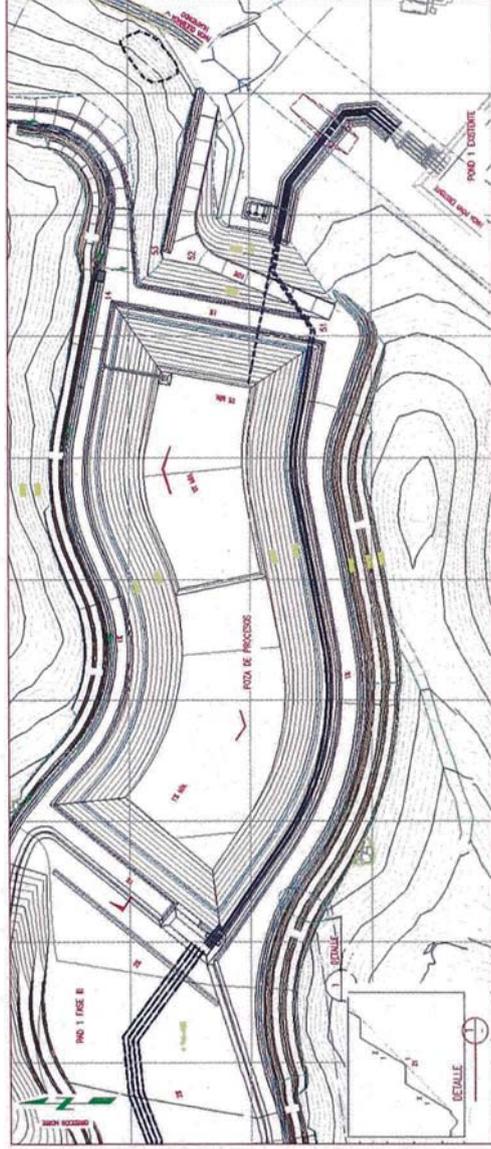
Poza de Procesos (Vista en planta y perfil)
